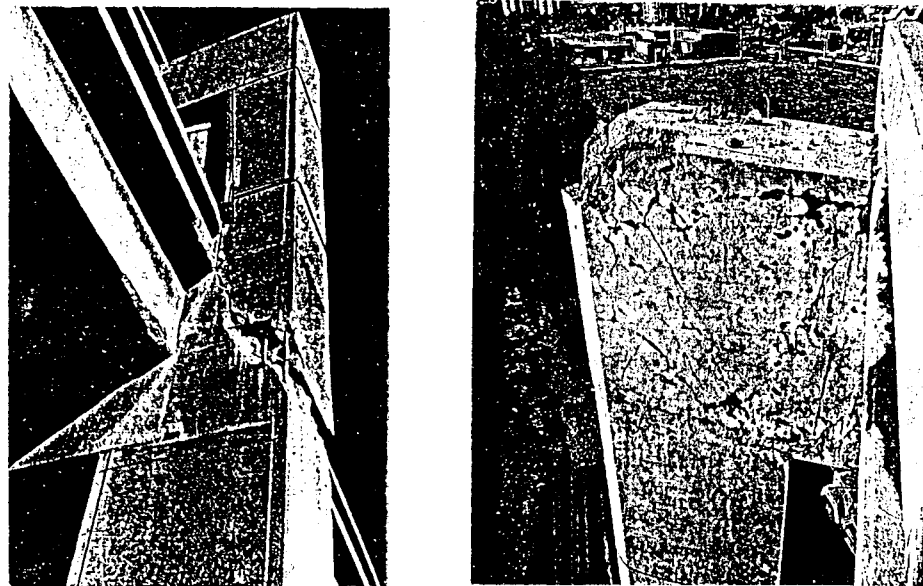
Kegagalan struktur akibat geser (Priestley, 1996)
